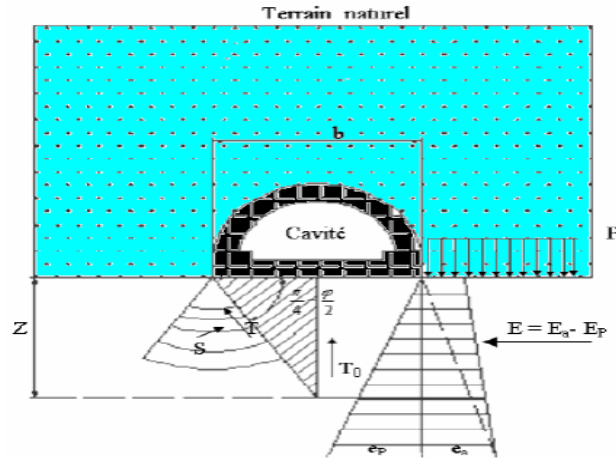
La poussée au niveau de radier selon TSIMBRIEVITCH.
